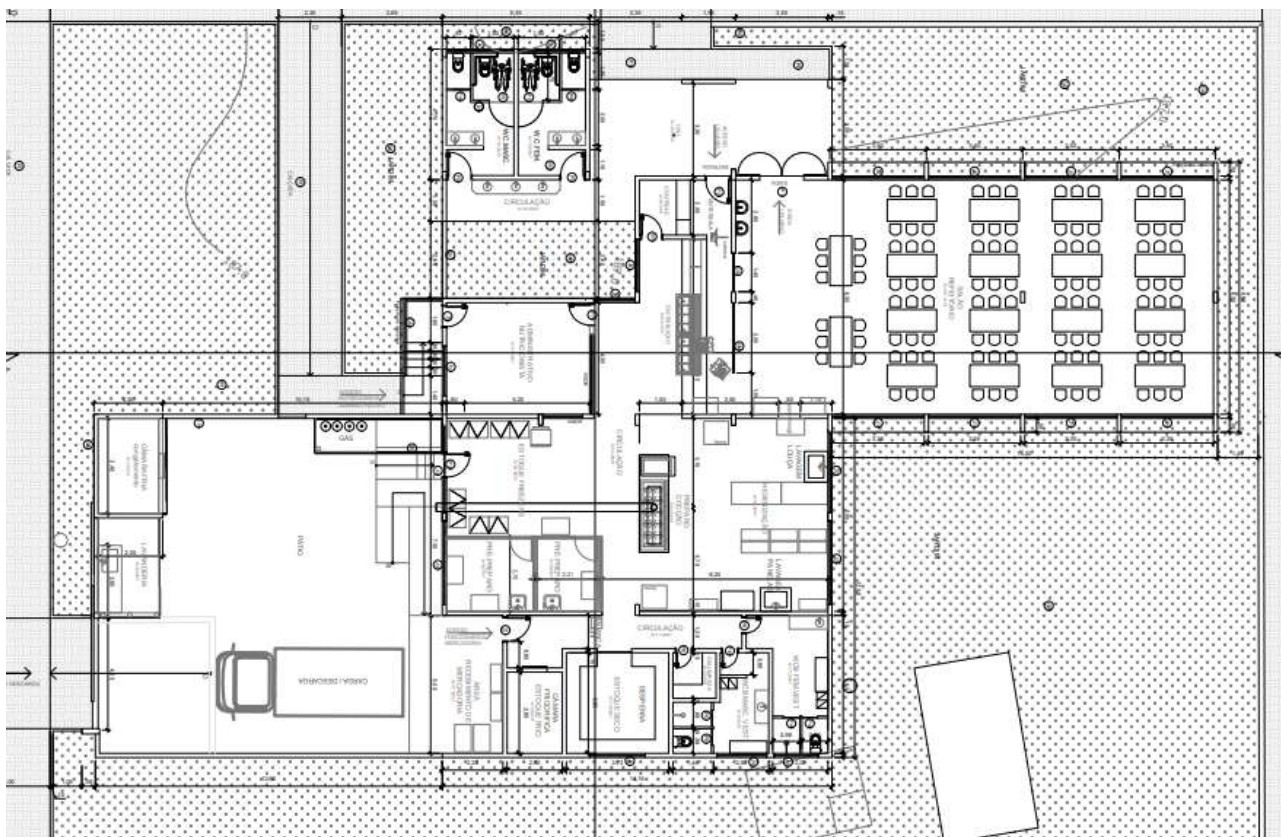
Planta Baixa da Edificação RU do CCTA/UFCG. Fonte: PU/UFCG
